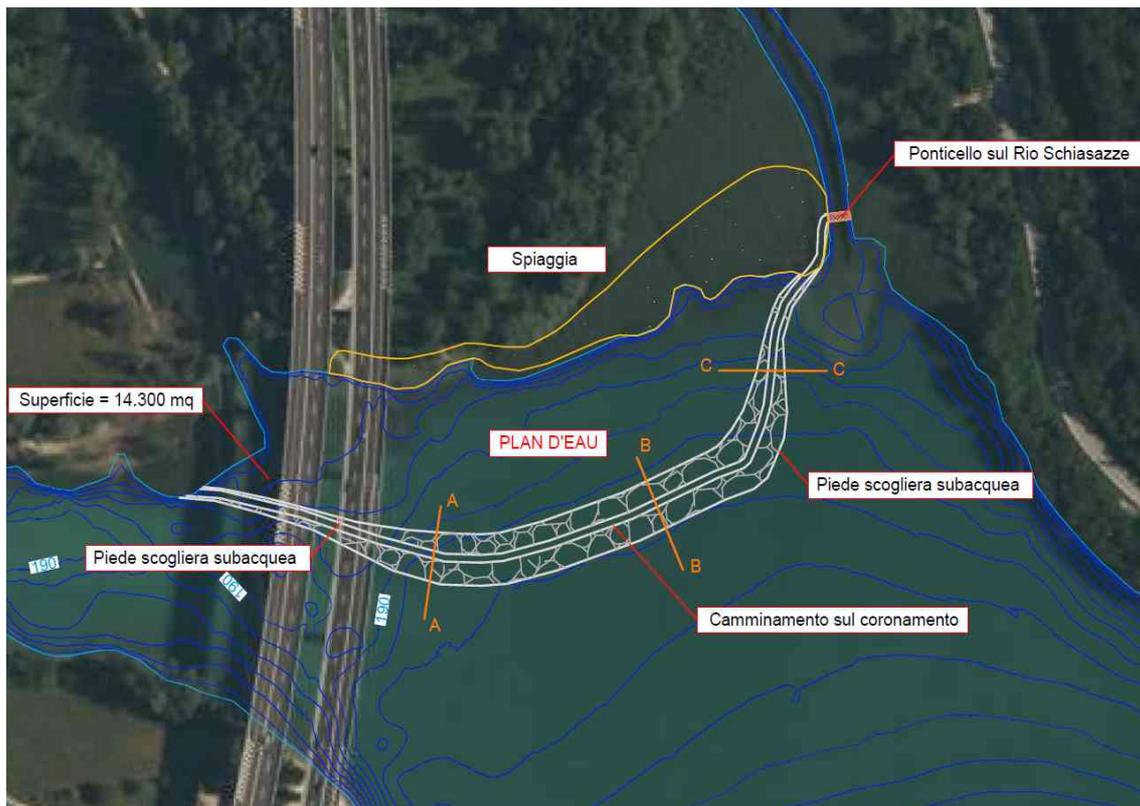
Planimetria del plan d'eau n. 2, presso Somplago.
